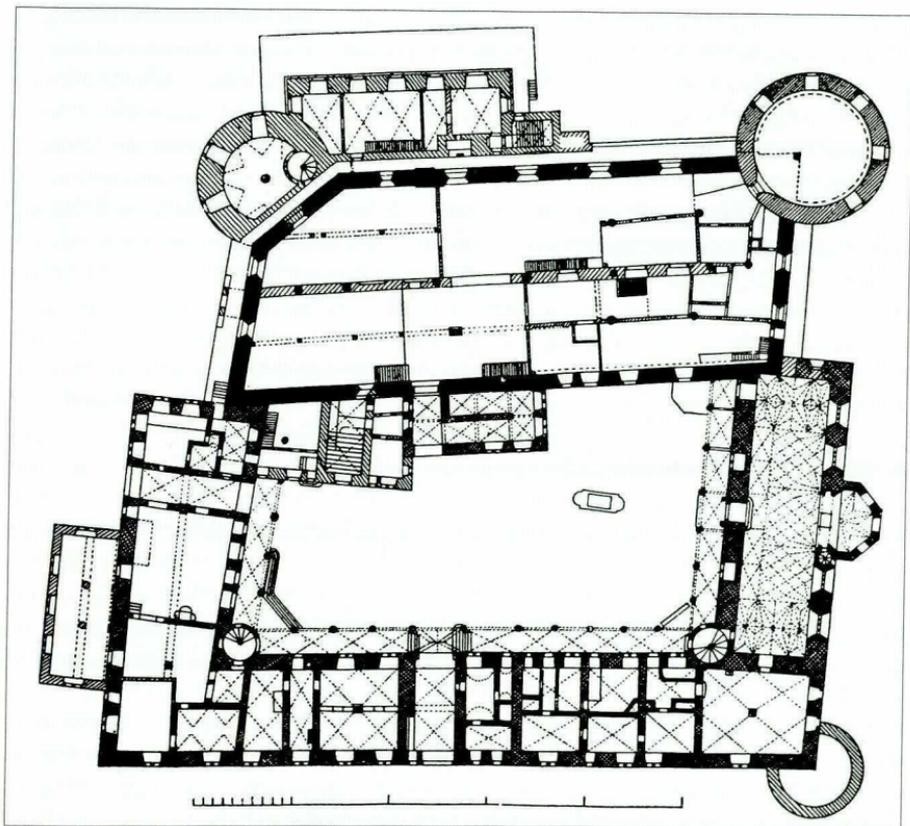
Altes Schloß Stuttgart, Grundriß, Zustand um 1573.
